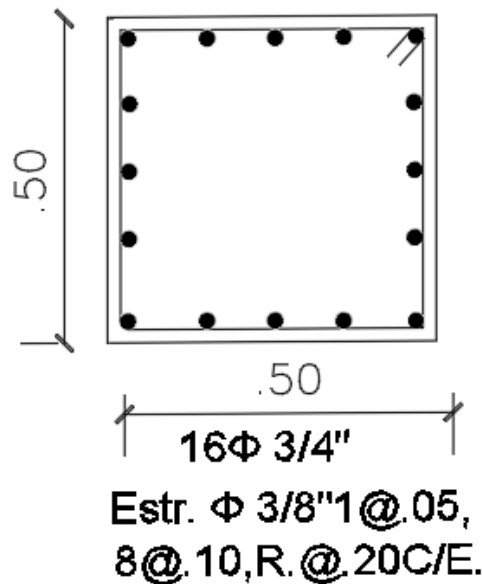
Detalle del acero de refuerzo de la sección de las columnas empleadas en el sistema aporticado.
